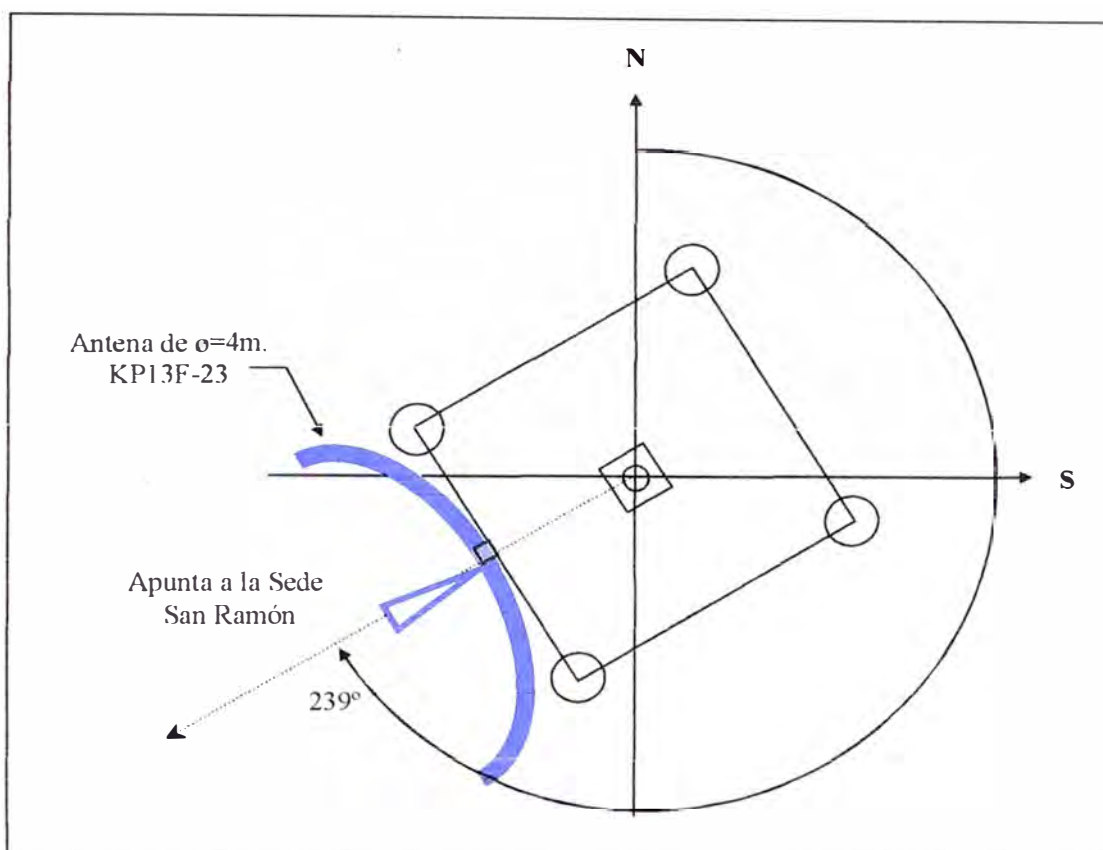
Vista de Planta de la Torre – San Ramón
